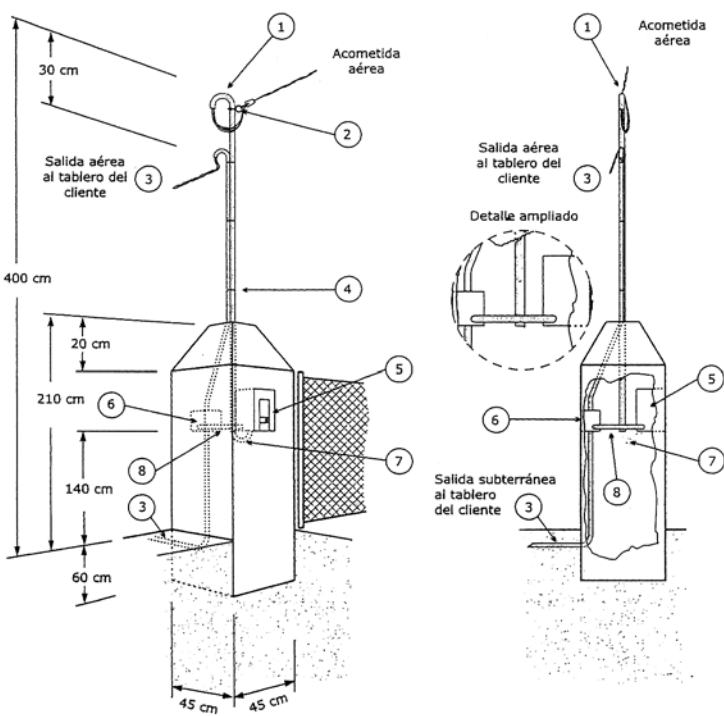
Acometida aérea, tarifa T1 de Edenor. Pilar de mampostería con el caño pilar
